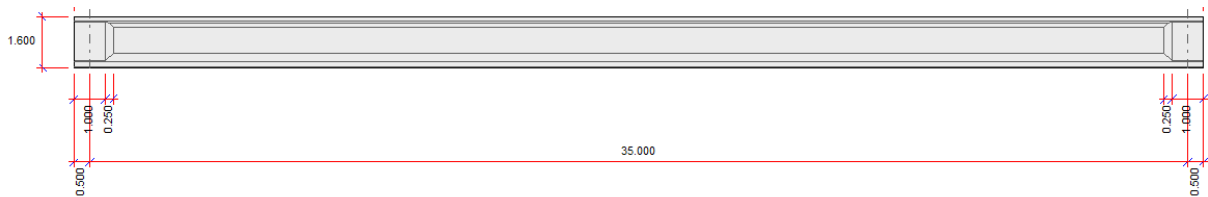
Alzado de viga. Fuente: IDOM-DEHC.
